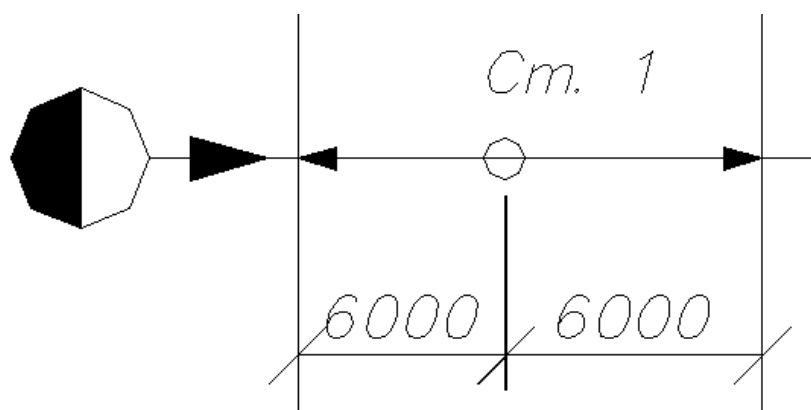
Схема роботи крана на станції 1 для монтажу ферм
